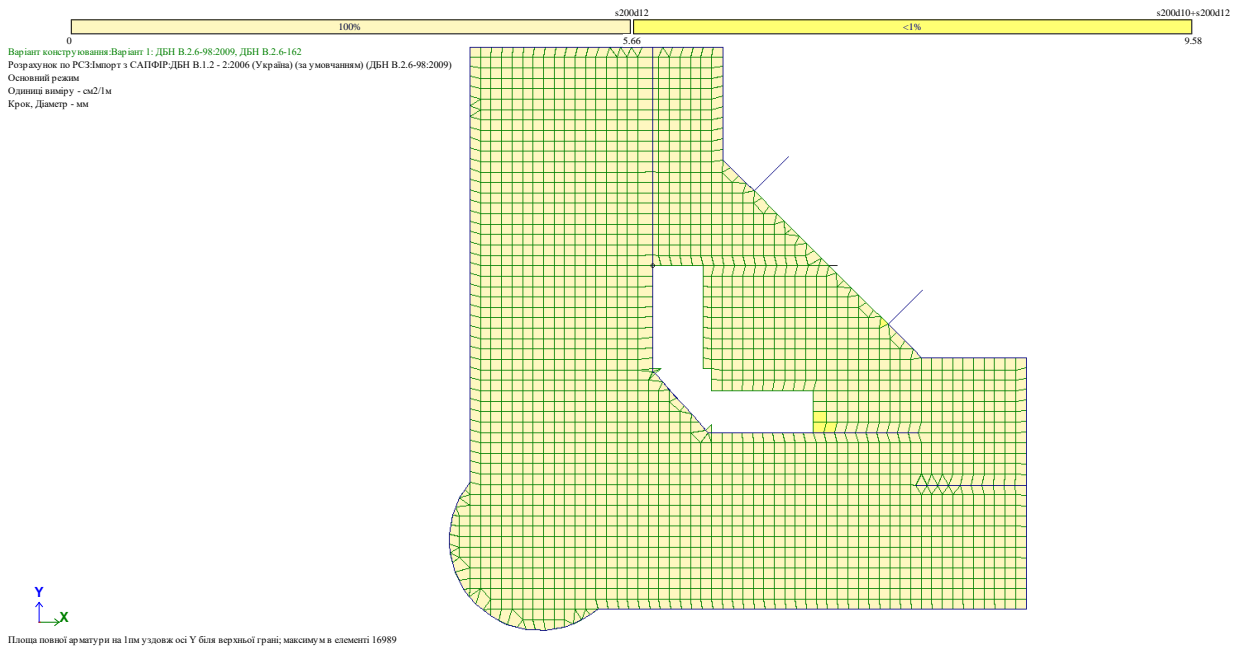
Площа повної арматури на 1м уздовж осі Y біля верхньої грані для плити перекриття 2-го поверху
